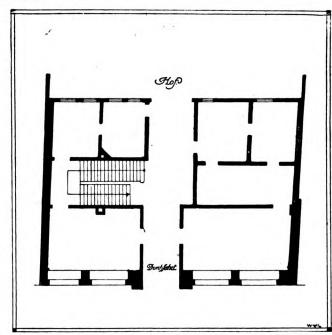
Erdgeschoß von Gördelingerstraße 44 (Stadtbauamt)
